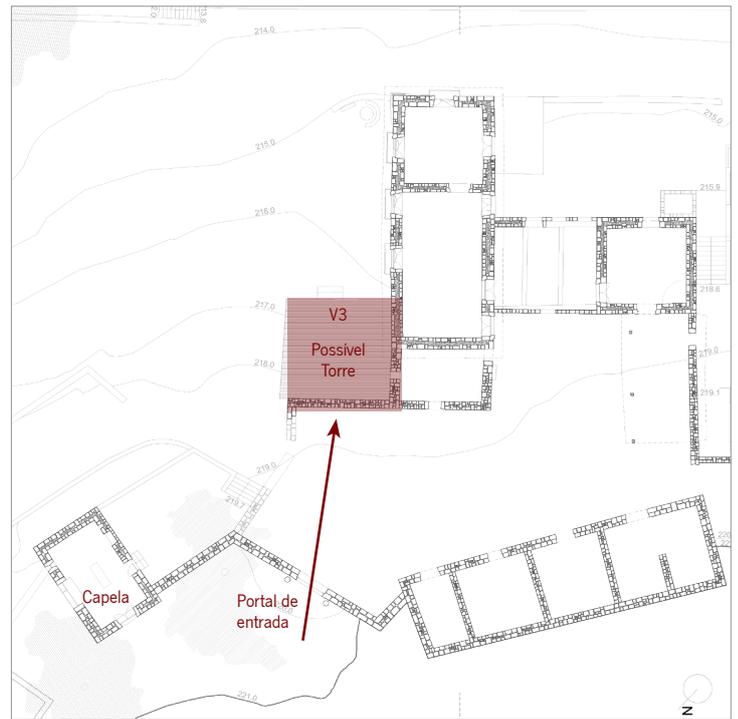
Planta do piso superior do conjunto edificado de São Miguel (Esc. 1:500)
